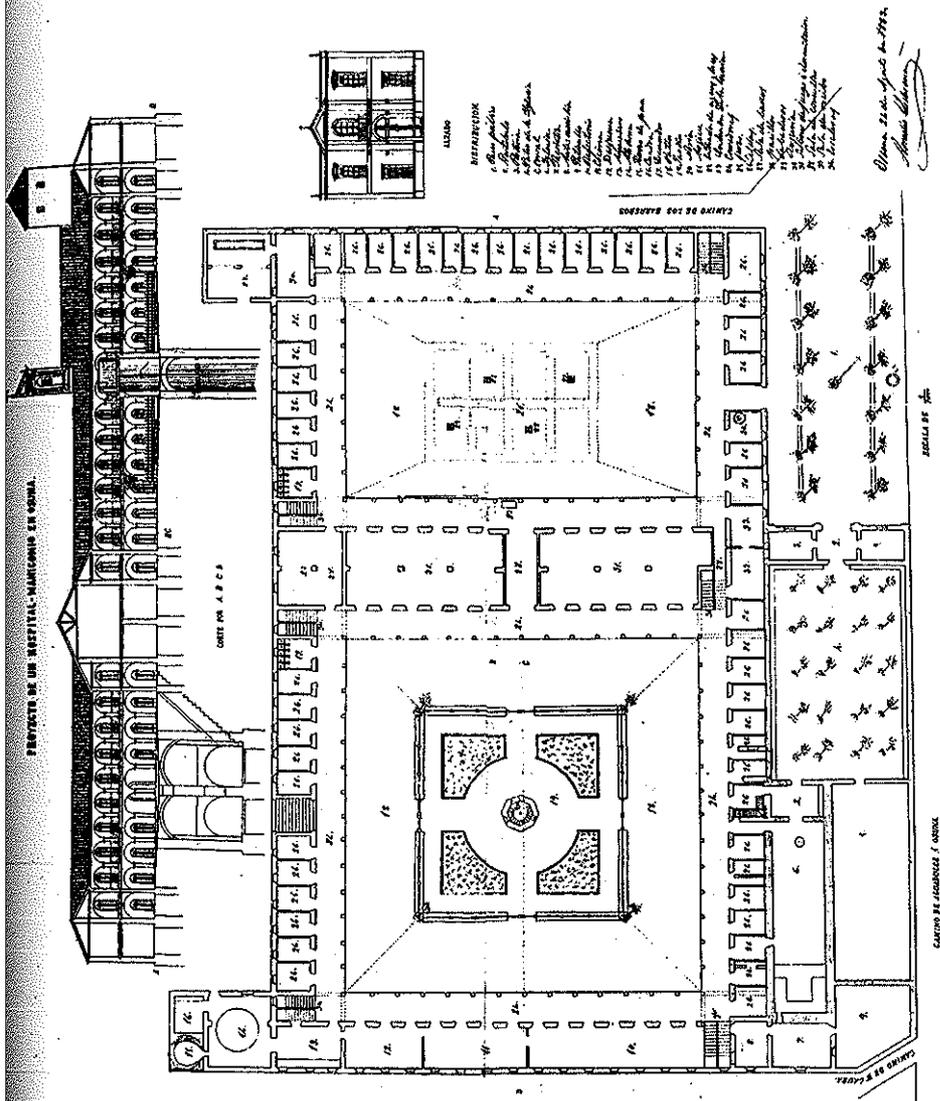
Plano pormenorizado del proyecto del Manicomio de Santa Ana, por Arcadio Ledesma (1883).
